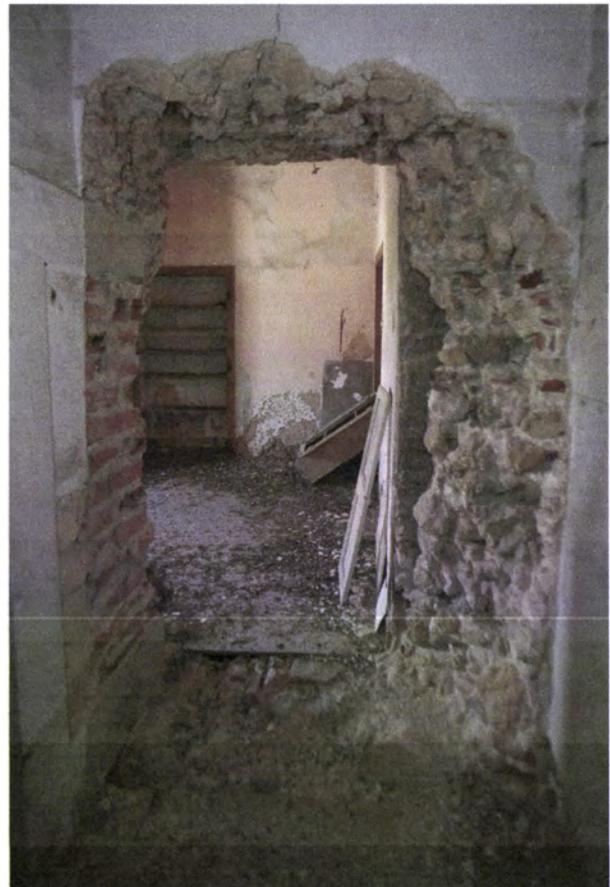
Foto da autora – Paredes interiores em alvenaria de pedra e tijolo de «burro».
